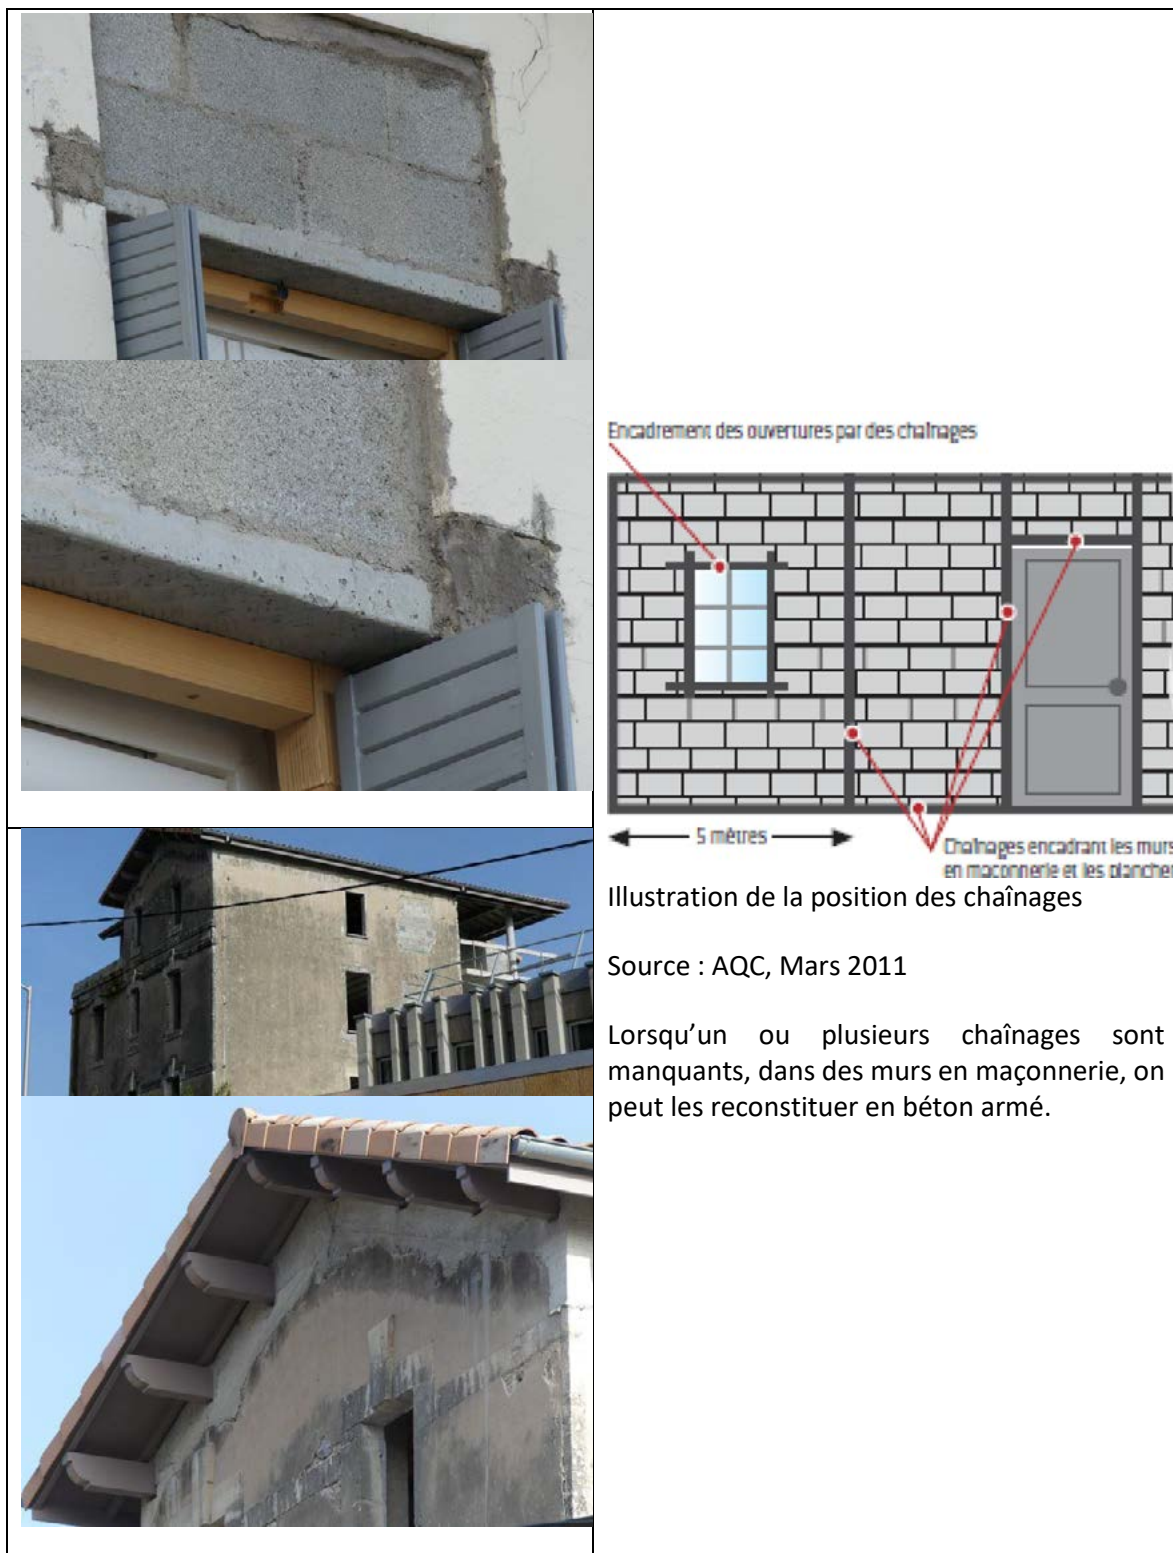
A gauche, de bas en haut : exemple de travaux de mise linteau béton en encadrement de fenêtre ; exemples de travaux de réalisation de chaînage en béton armé de couronnement de mur en combles ; à droite : préconisations issues du Guide DGPR.
